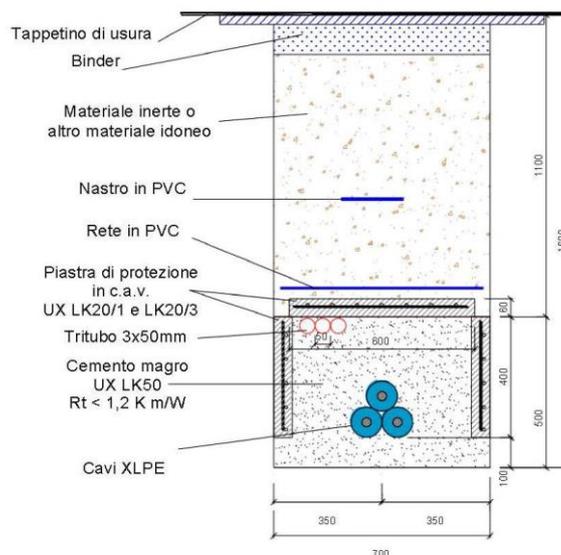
Tipico di posa terna di cavi AT 150 kV su sede stradale
